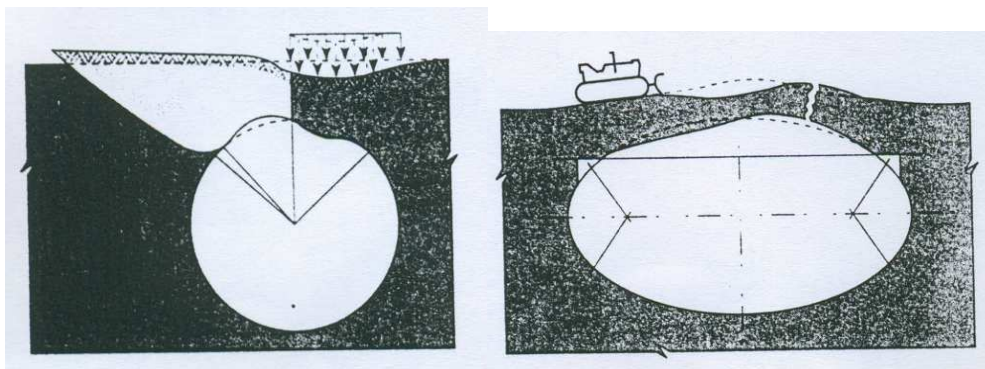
Deformacja konstrukcji z blach falistych wskutek niewłaściwego zagęszczania zasypki gruntowej wokół konstrukcji
